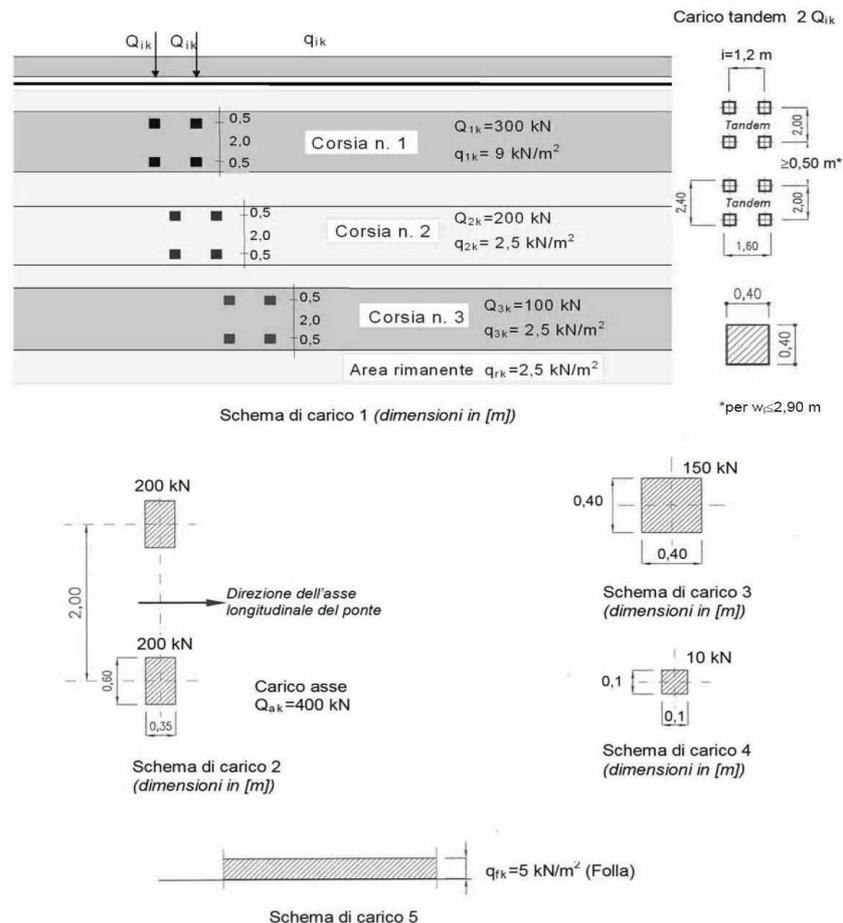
Schemi di carico 1 – 5 (dimensioni in m)
